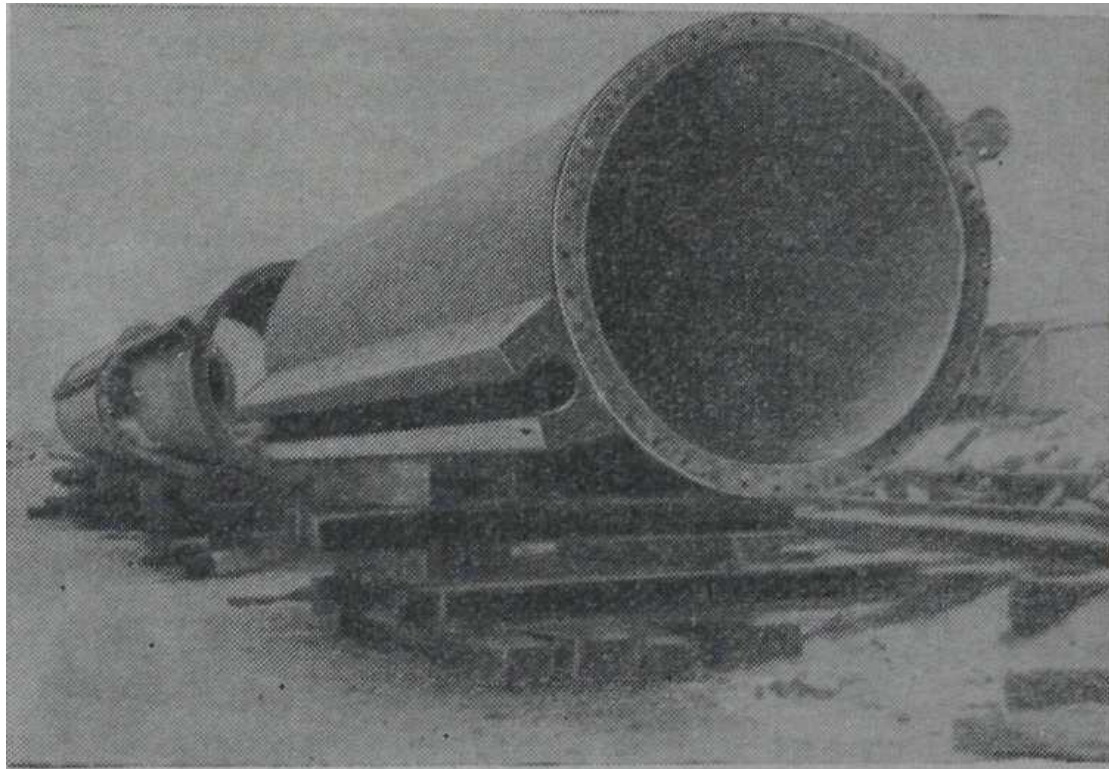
Залізобетонний шпунт трубчастий
